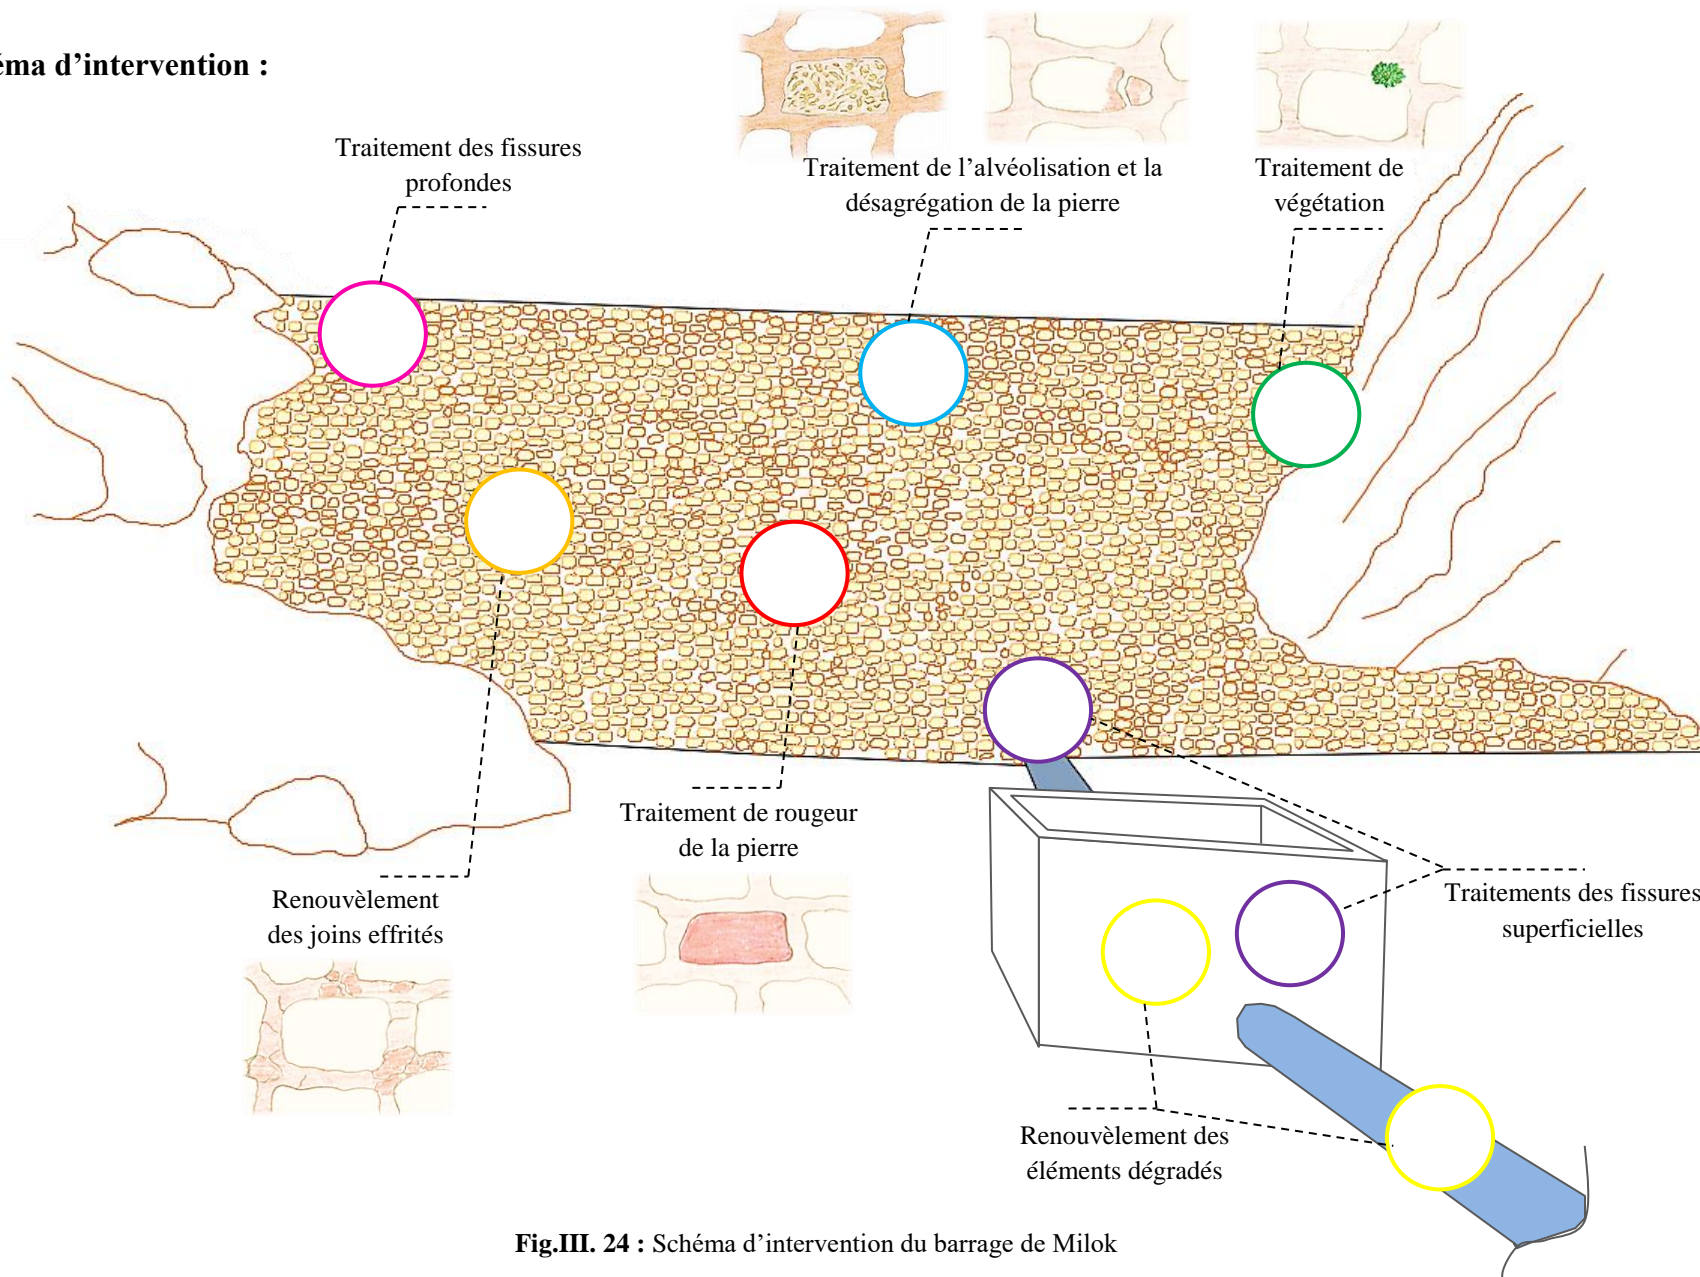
Schéma d'intervention du barrage de Milok
